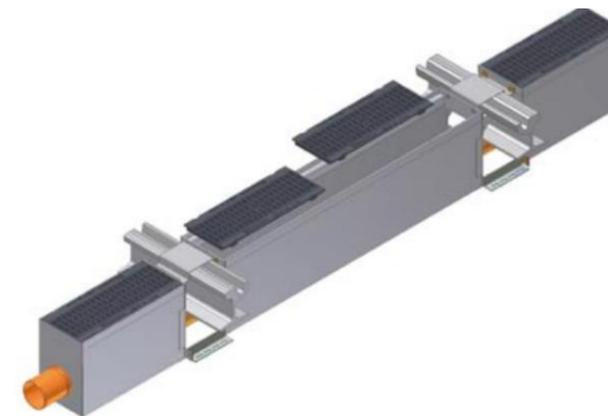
Detalle de los elementos de drenaje de la plataforma en secciones con terminación en Hormigón y M.B.C.
